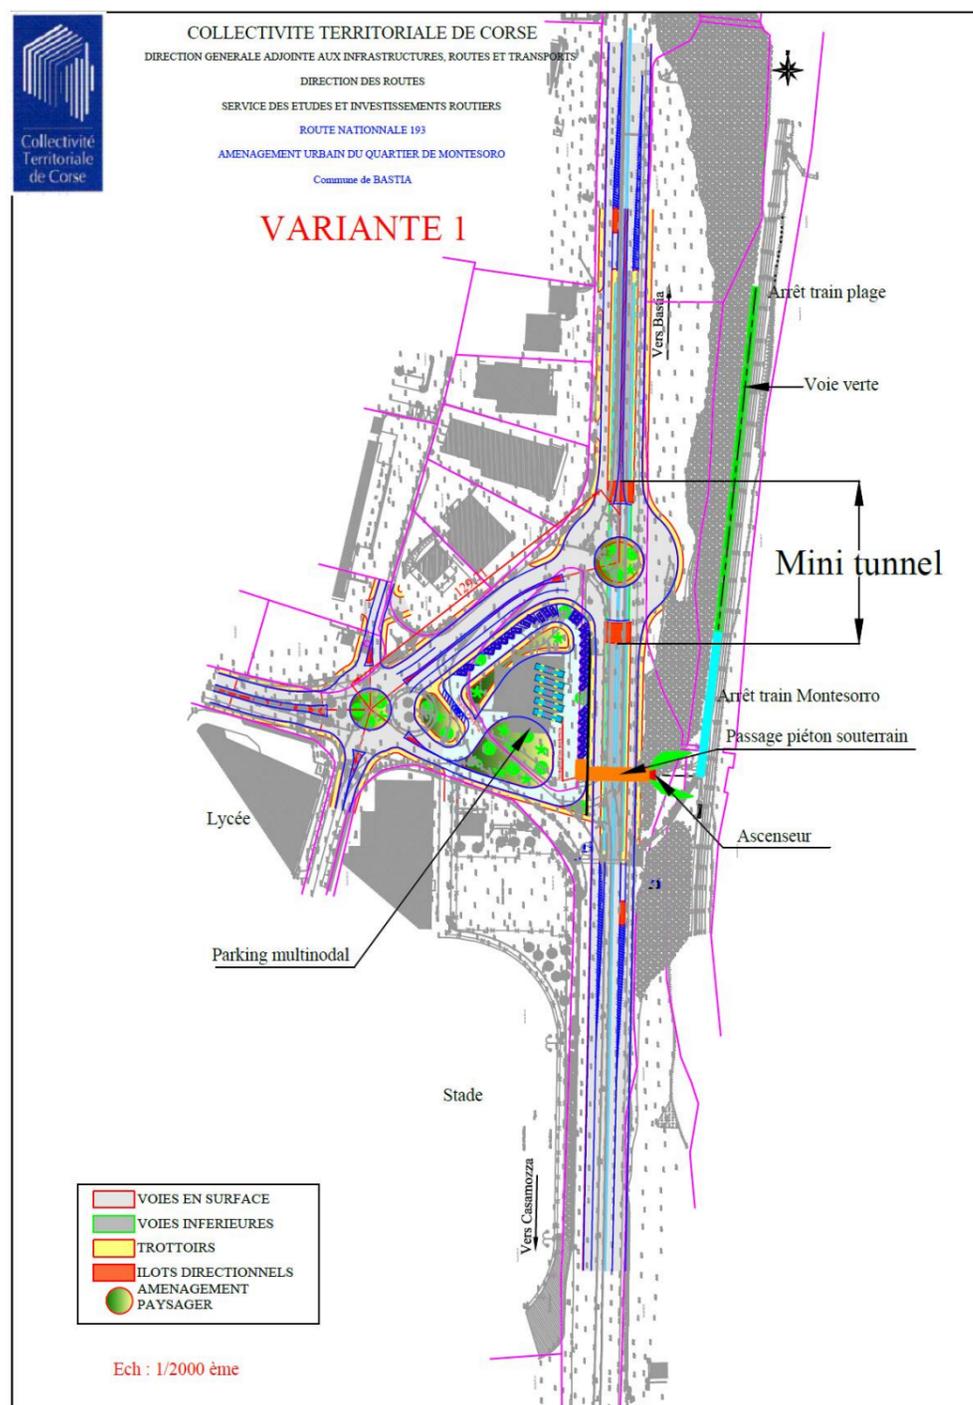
PLAN MASSE DE LA VARIANTE 1
